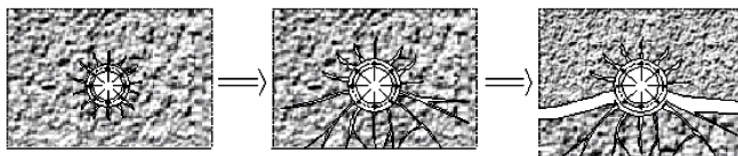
Fisurarea și dislocarea betonului în zona barei corodate
